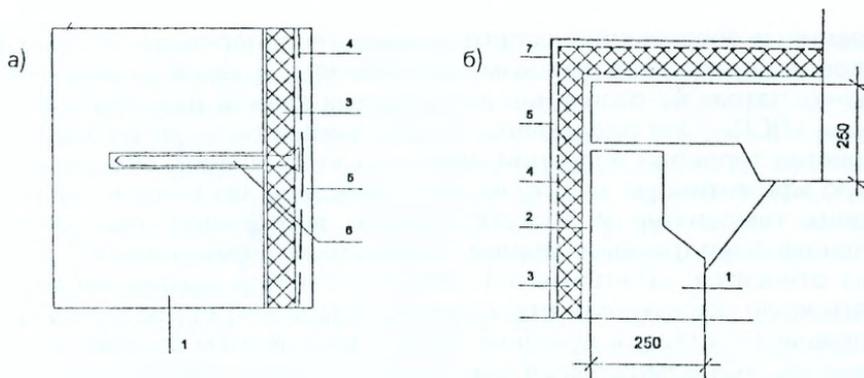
Детали тепловой изоляции наружных стен по системе «ПСЛ»:
